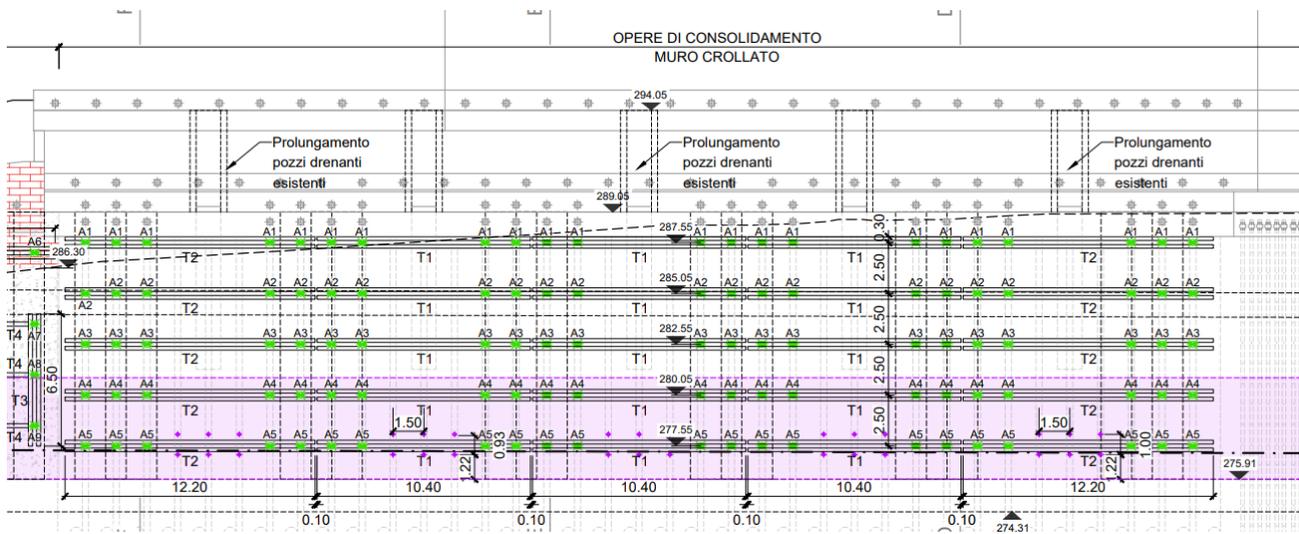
Stralcio del prospetto degli interventi sul muro crollato consolidato.
